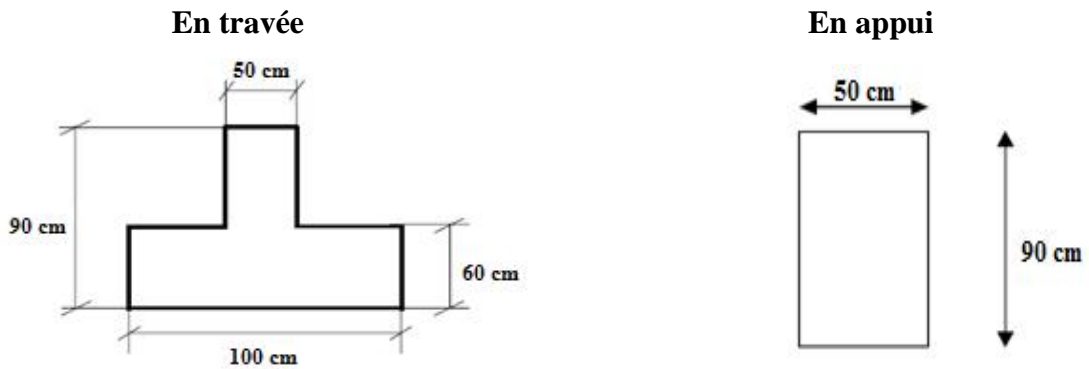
Schéma d'une coupe transversale en travée et en appui.
